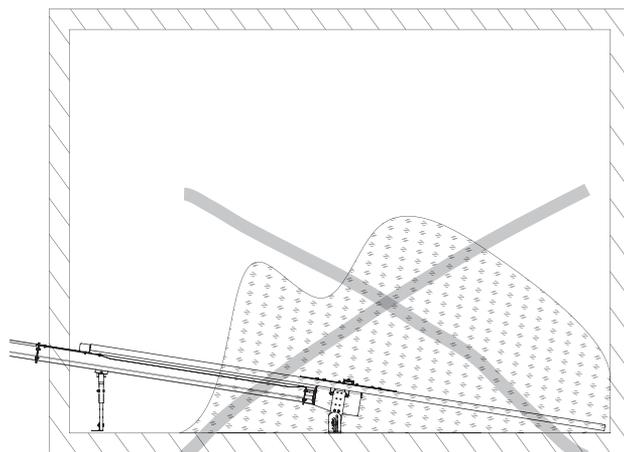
Premier remplissage INCORRECT du silo de combustible
